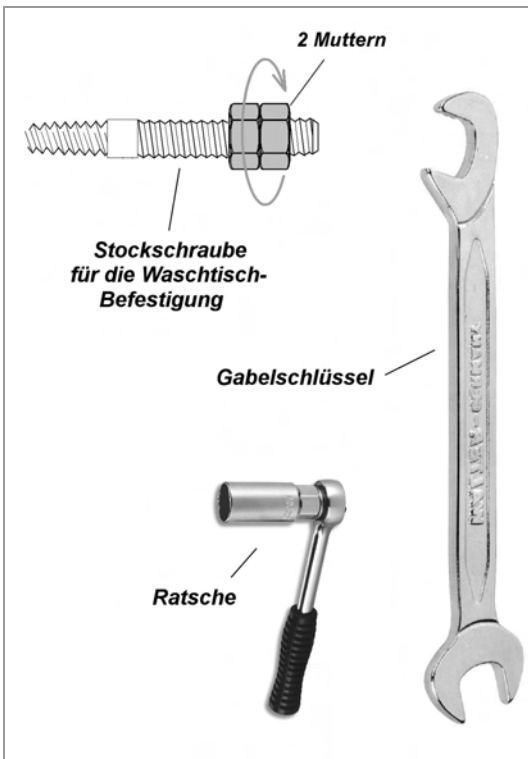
Um eine Stockschraube in den Wanddübel fest montieren zu können, werden an der Schraube (vorübergehend) zwei Muttern kräftig zusammengedreht, mit deren Hilfe sie sich dann mit einem Gabelschlüssel oder mit einer Ratsche leicht einschrauben lassen.
